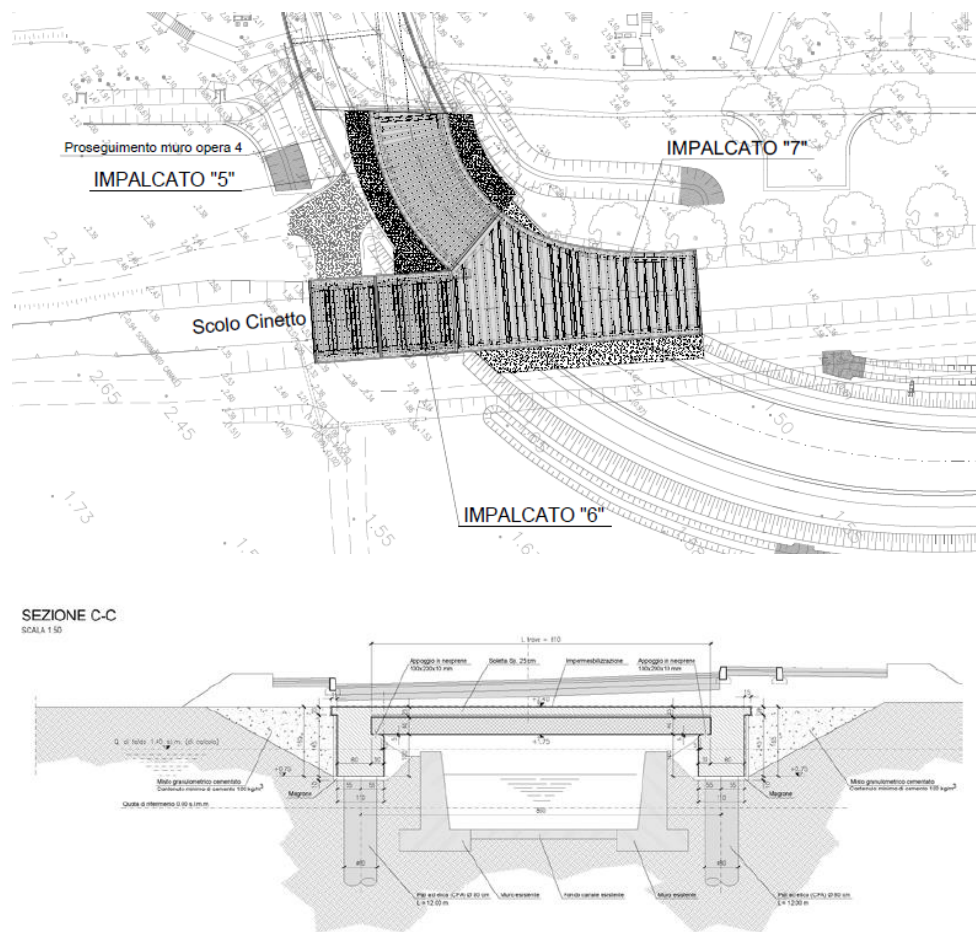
Impalcati 5, 6 e 7 Pianta e sezione
